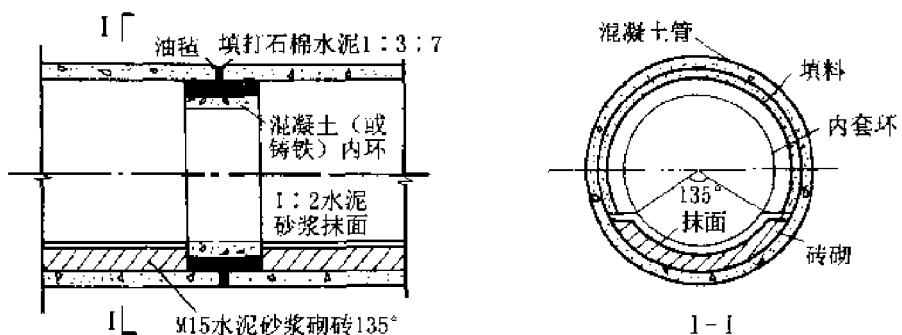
混凝土(或铸铁)内套环石棉水泥接口
